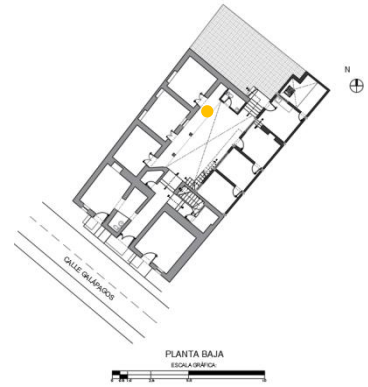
Eflorescencias en bodegas • Fuente: Ilustración Propia
